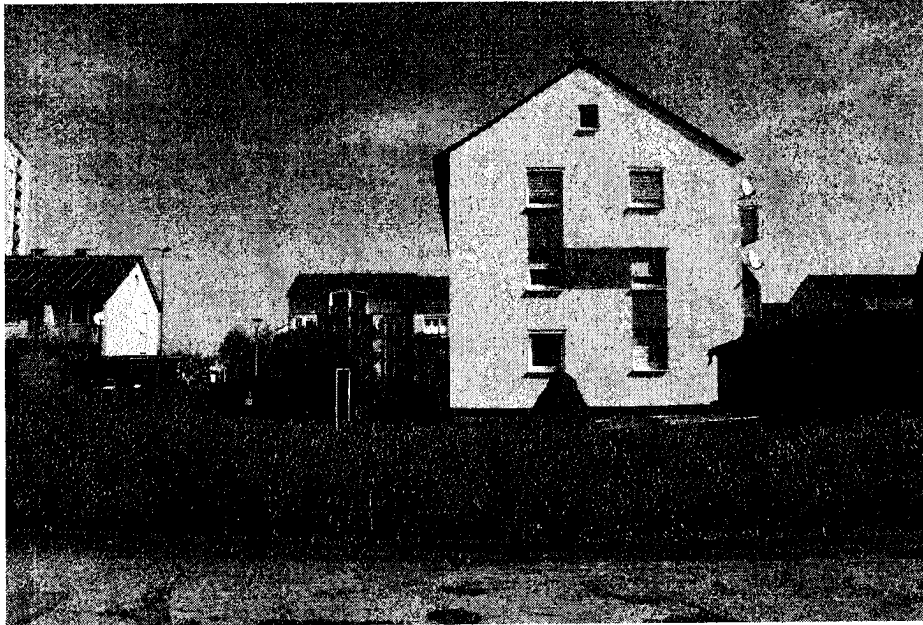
Nordansicht Straßenansicht (Roßfelder Straße)
